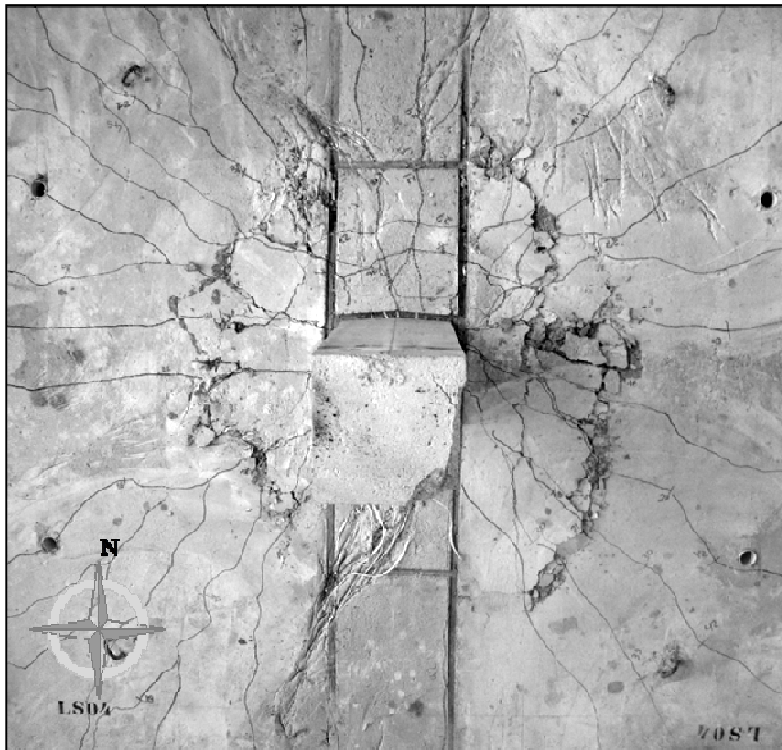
Mapa de fissuração da laje LS04
